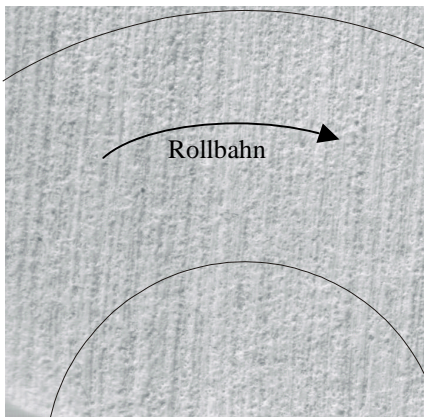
Die texturierte Oberfläche eines „hochfesten“ Straßenbetons nach 90.000 Überrollungen
